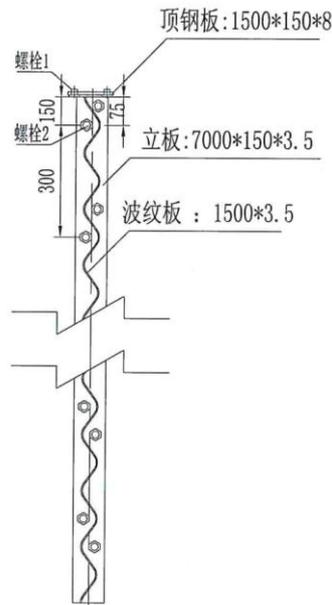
钢波纹板铆接示意图（钢波纹板侧面图）
